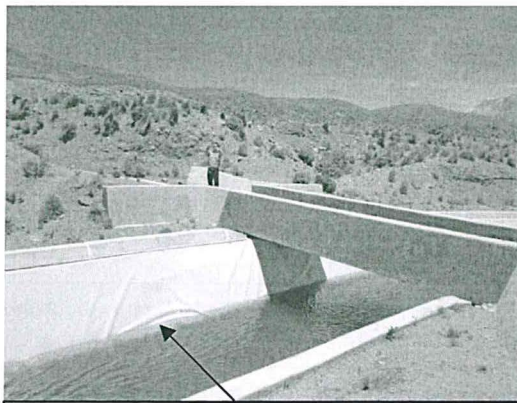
CANAL UCHUSMA IMPERMEABILIZADO GEOMEMBRANA
